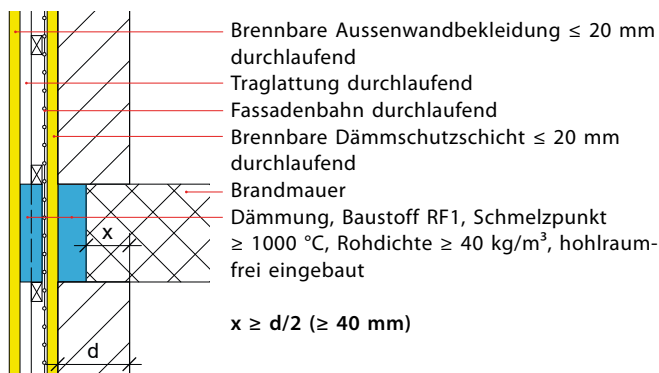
Brennbare Aussenwandbekleidung/Dämmschutzschicht ≤ 20 mm; Anschluss von Brandmauern an die Aussenwand
